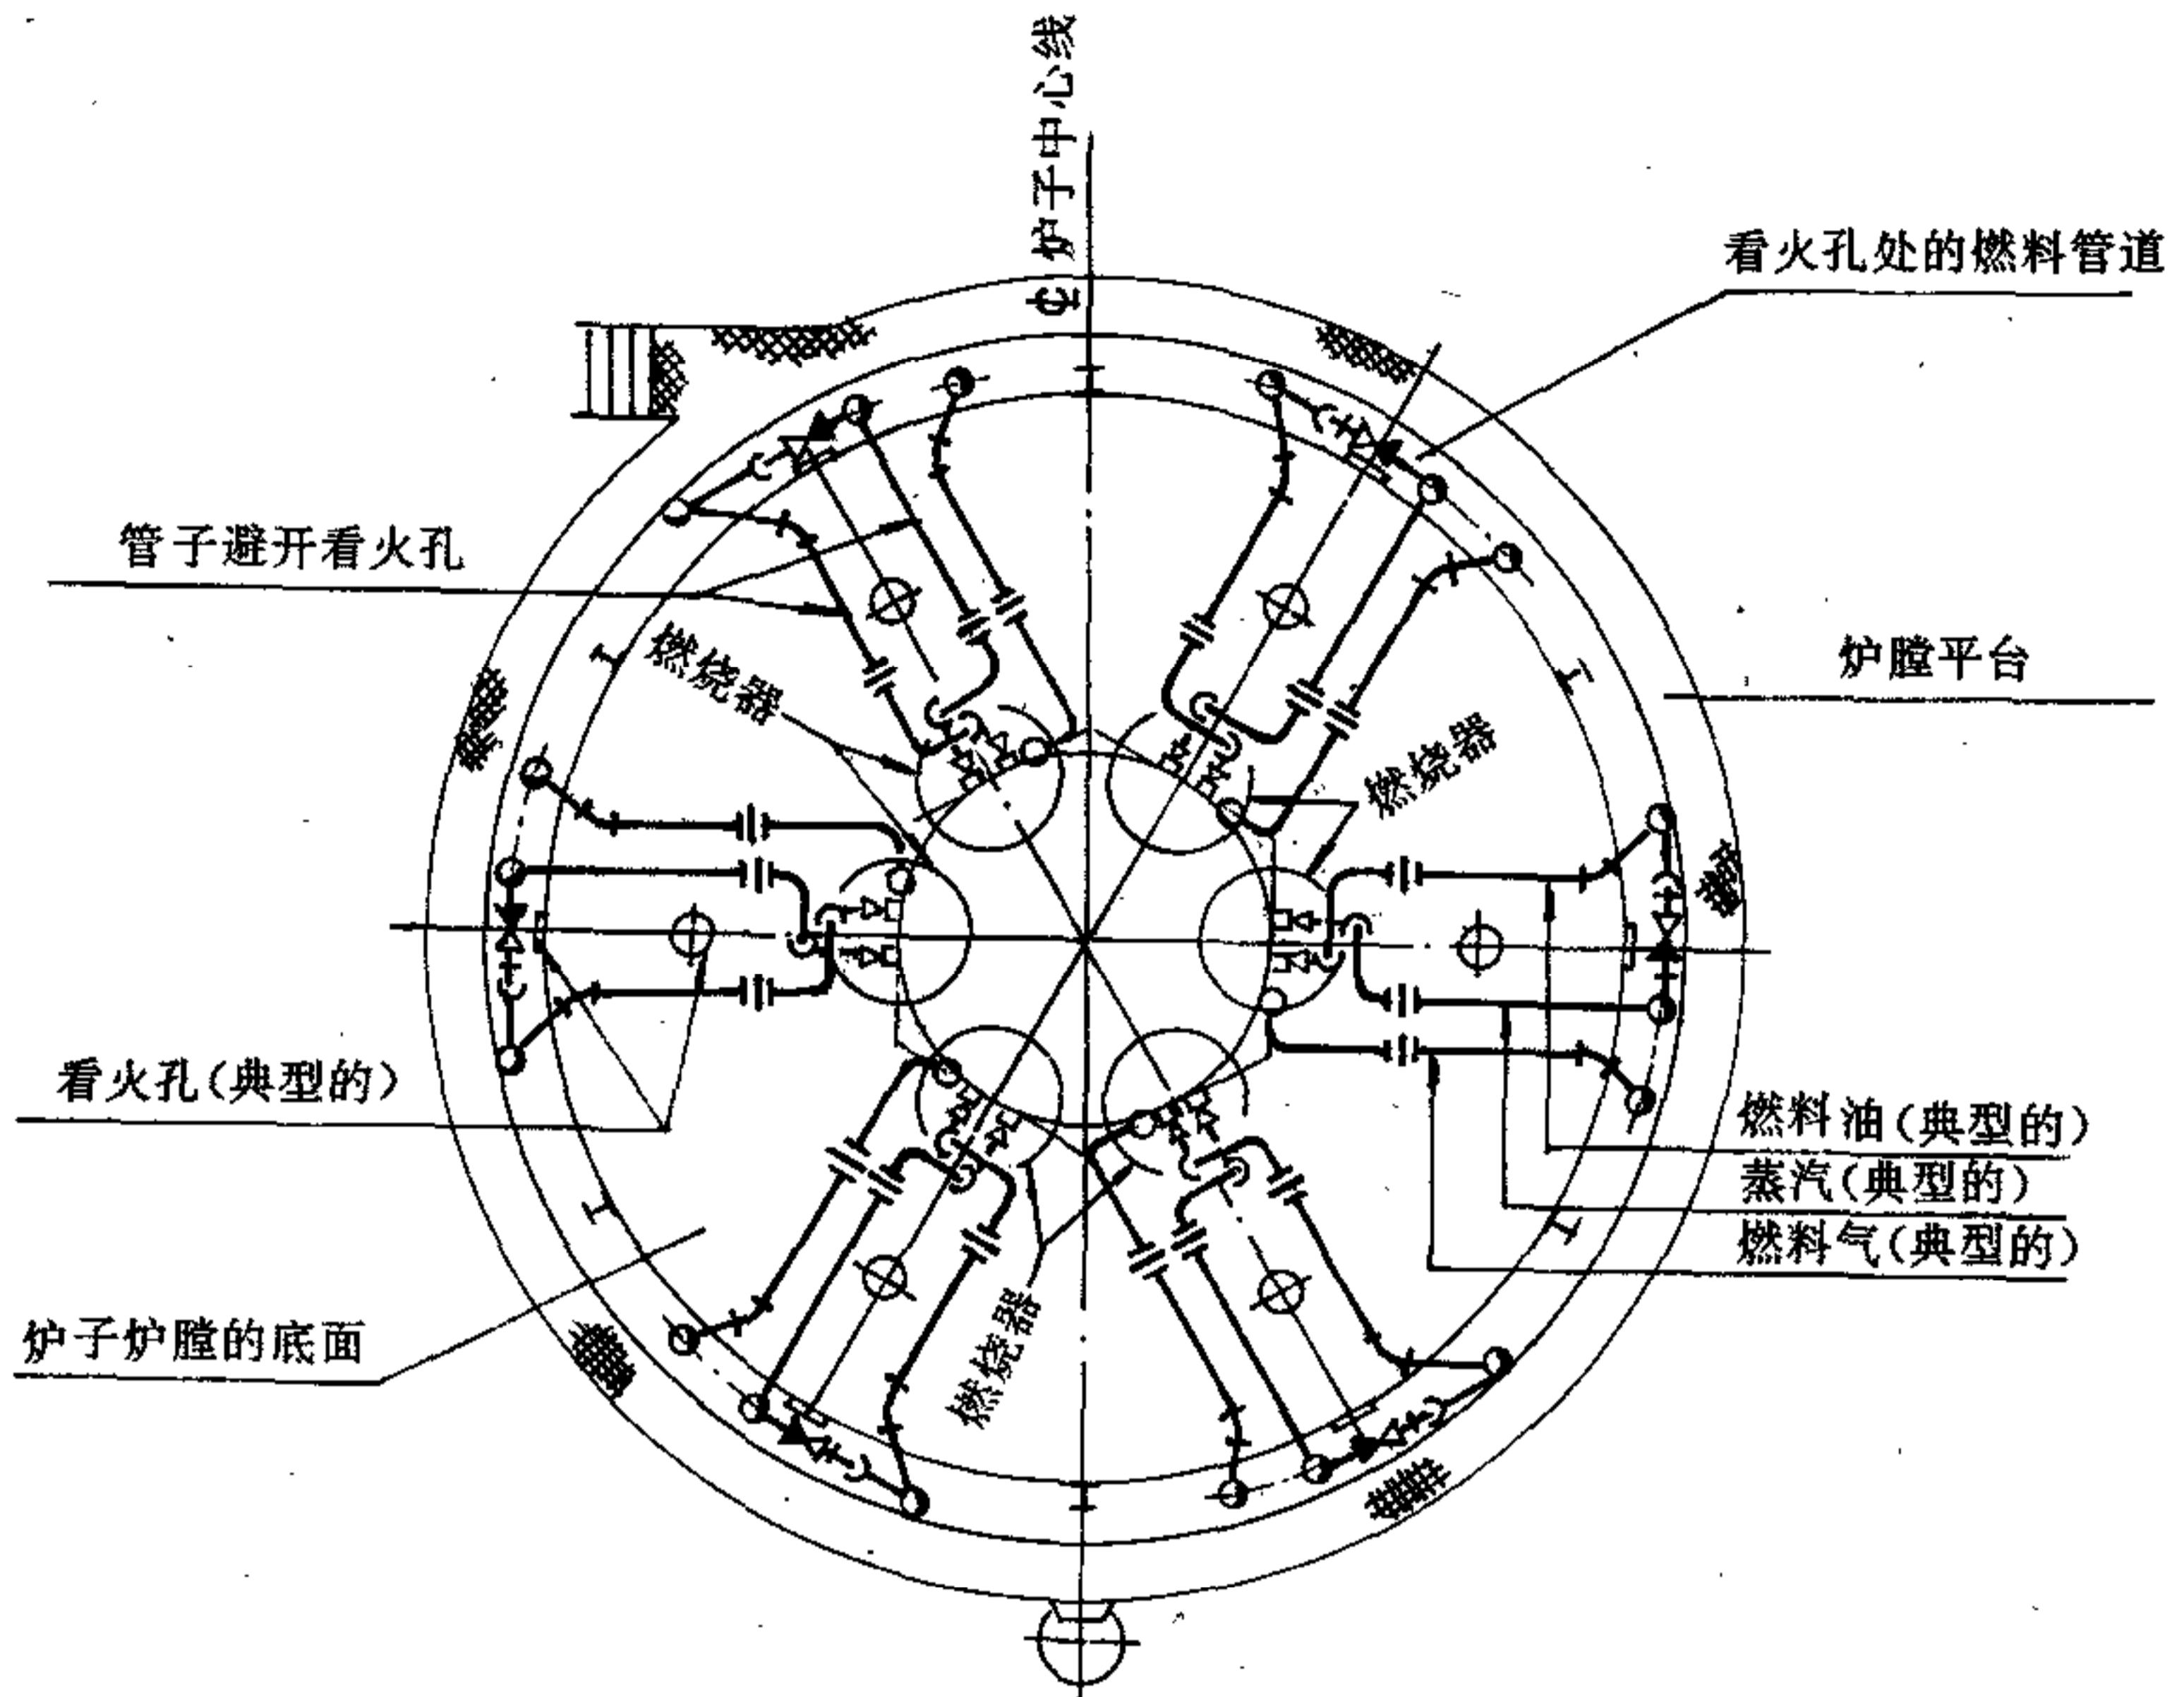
5 圆筒炉底部燃烧器配管平面图
